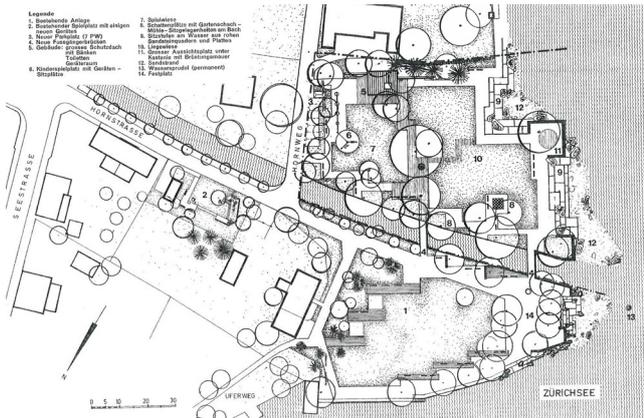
Plan Büro Zulauf, Baden, erweitert 1971
